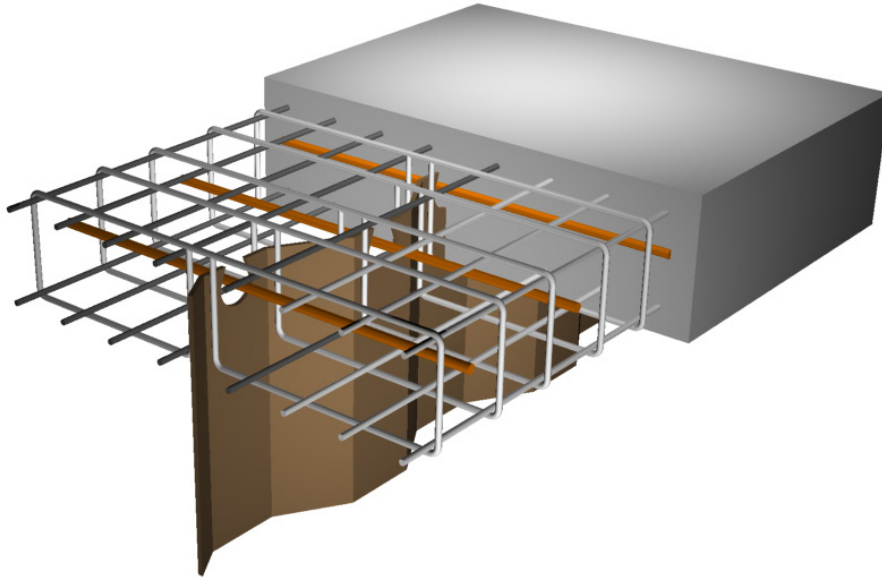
Bewehrungsführung des Push-out-Körpers
